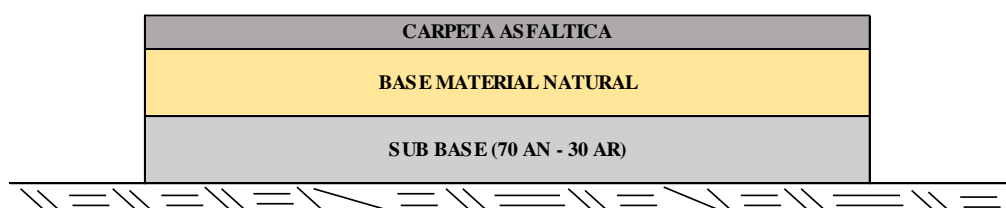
Espesores calculados de pavimento 3 para 10 000 000 EE
